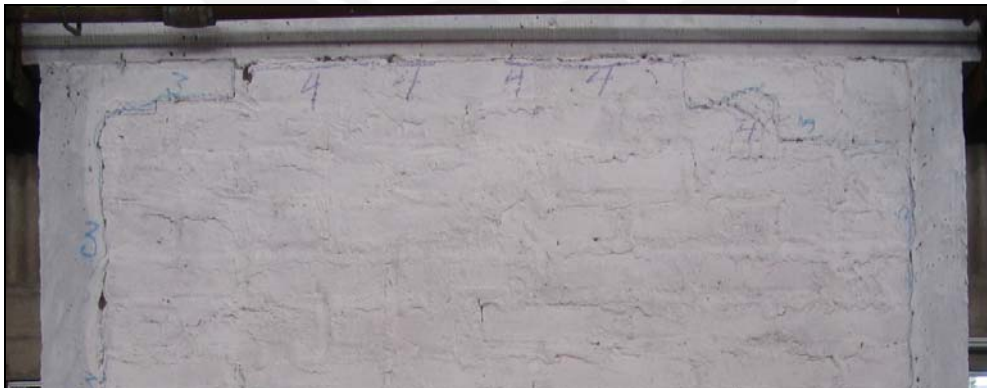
Fisuración de la unión columna-muro-solera.
